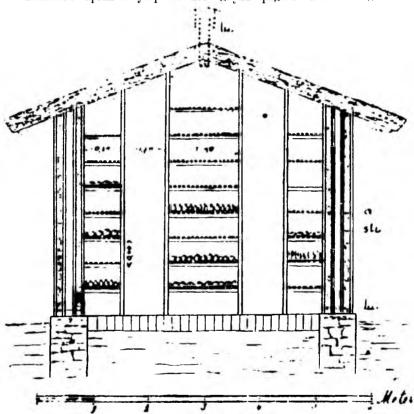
Поперечный разрёзъ Гейзенгеймскаго плодохранилища.
